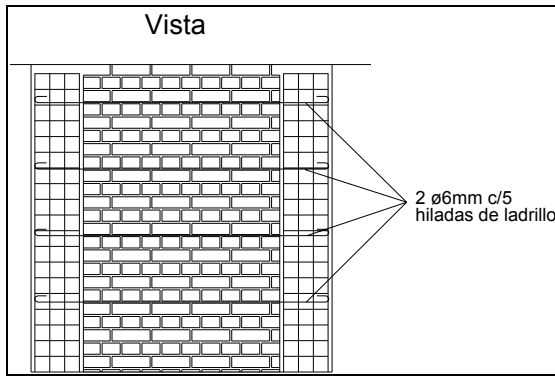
a): Disposición de armaduras en vista de los muros sismorresistentes
